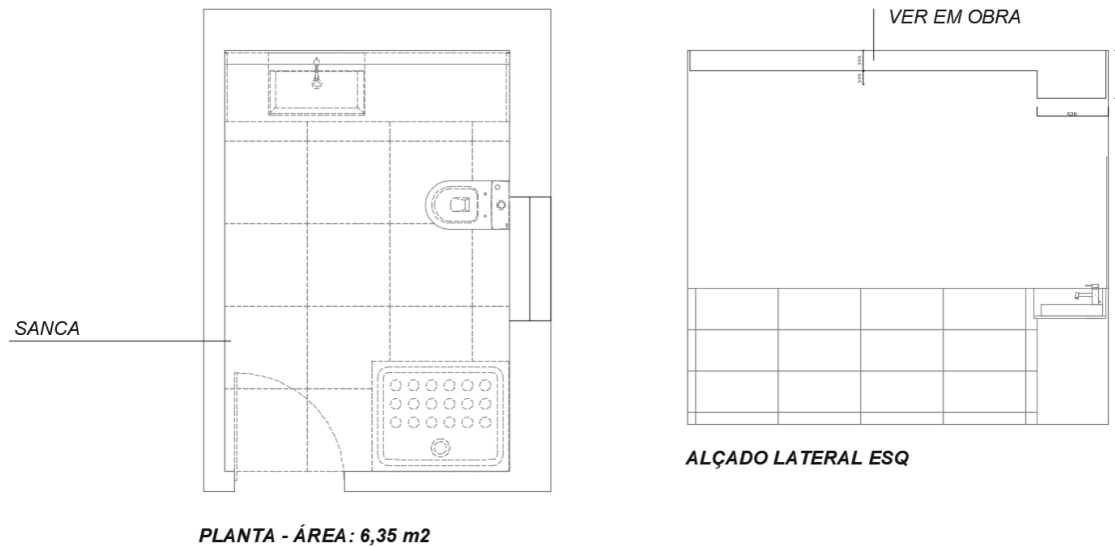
Planta e vista lateral do espaço. Escala 1/50.
